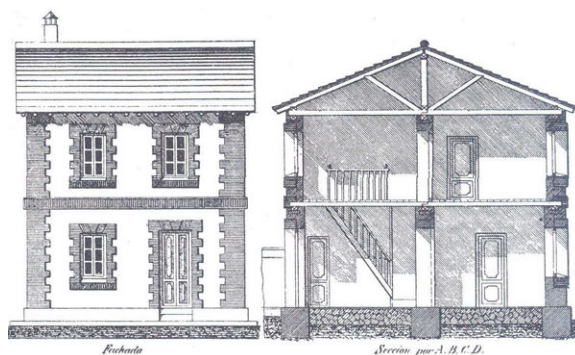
Fachada y sección de uno de los nuevos modelos de casa diseñados para la reconstrucción (López Arroyo, et al. 1980).
